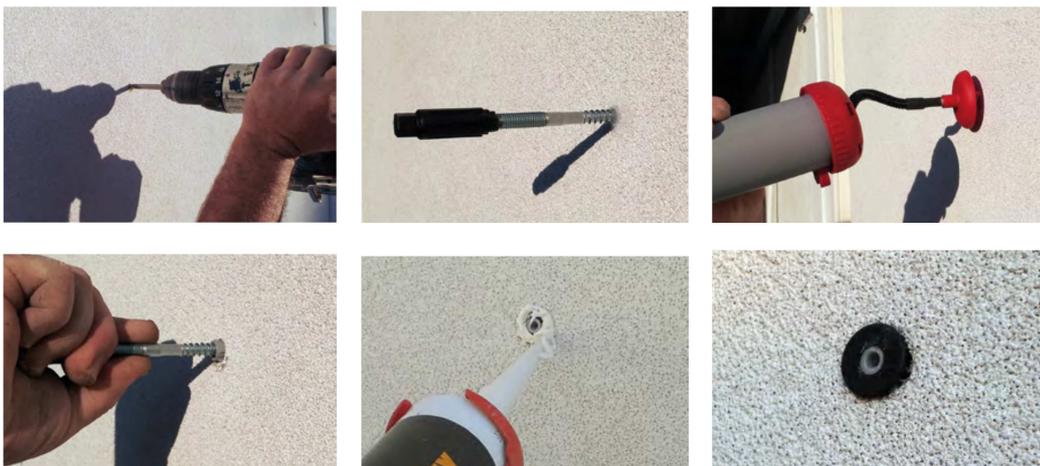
Elementos para anclaje de cargas pesadas de hasta 50 kg.
